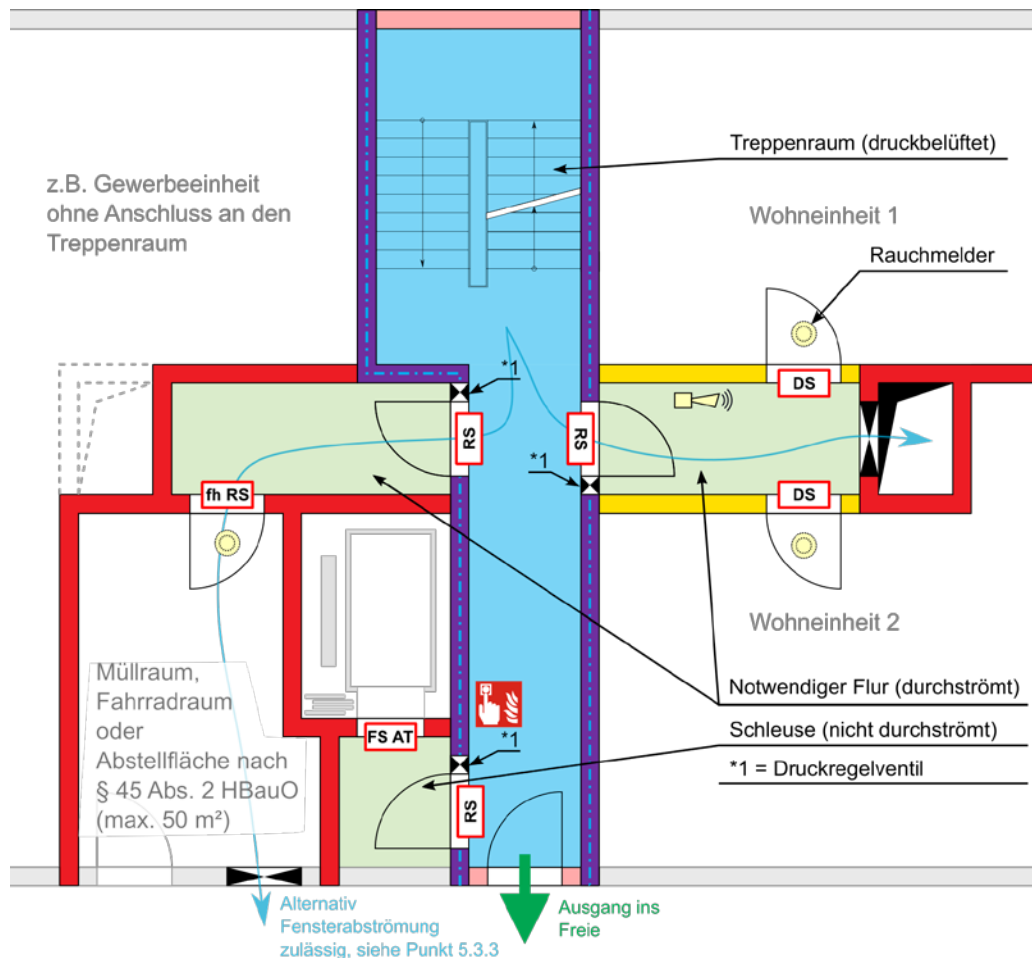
Prinzipskizze des Erdgeschosses eines Wohngebäudes der Gebäudeklasse 5 mit Anschluss an eine Abstellfläche nach § 45 Abs. 2 HBauO ([Hinweis/Legende](#))
